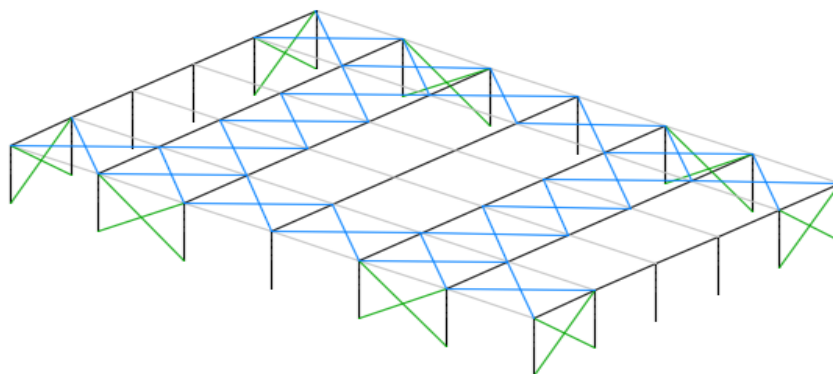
Sistema de contraventamento usualmente adotado em pórticos com vigas simplesmente apoiadas: cor azul – contraventamento de cobertura; cor verde – contraventamento vertical das fachadas; cor preta – estrutura principal. Adaptada de [1].
